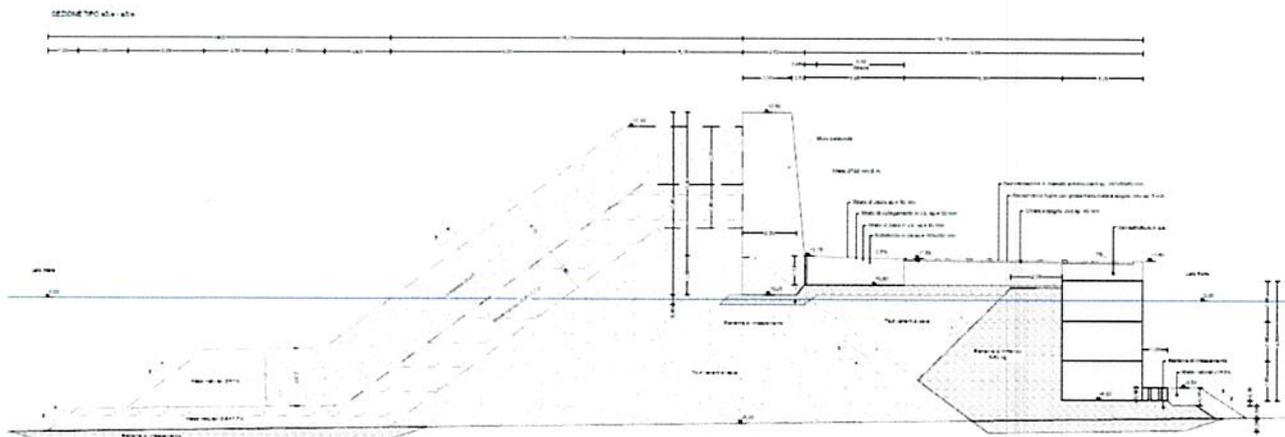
sezione tipo a3/a-a3/a (tav. EG\_OME 9)
